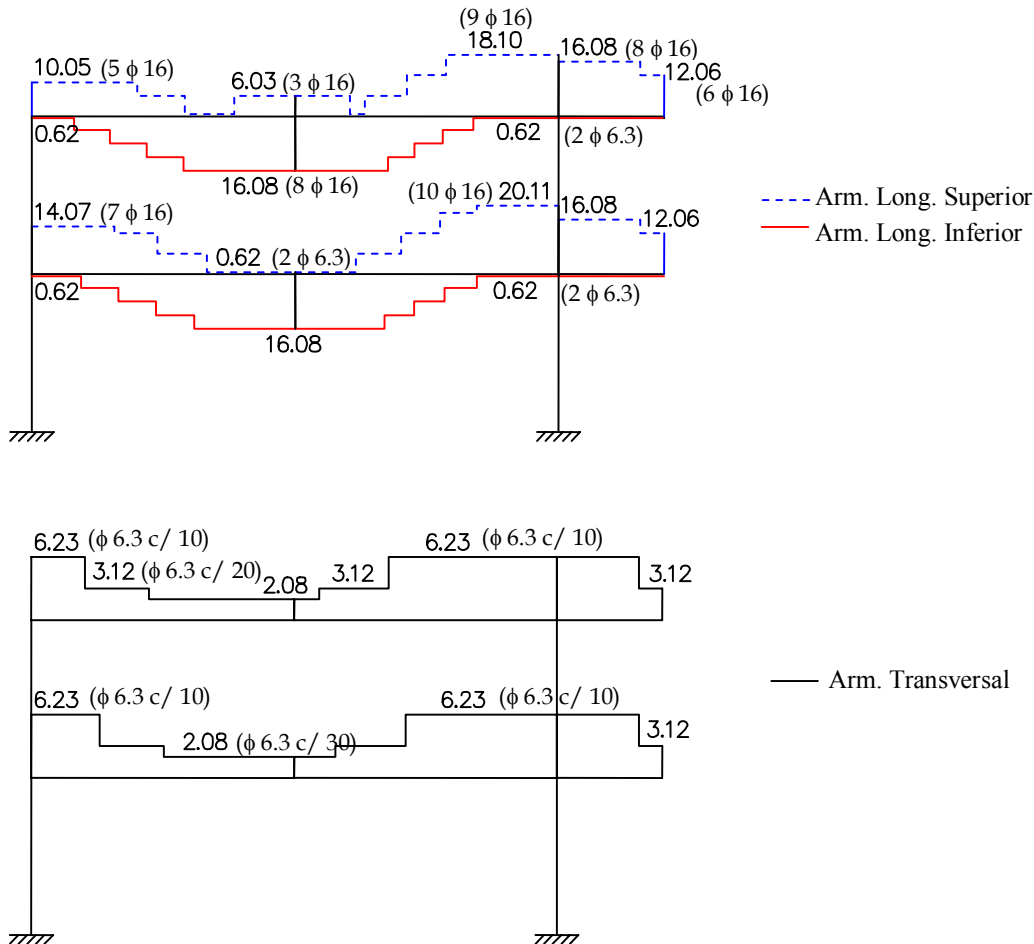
Diagramas de armadura adotada para o pórtico do Exemplo 3.
